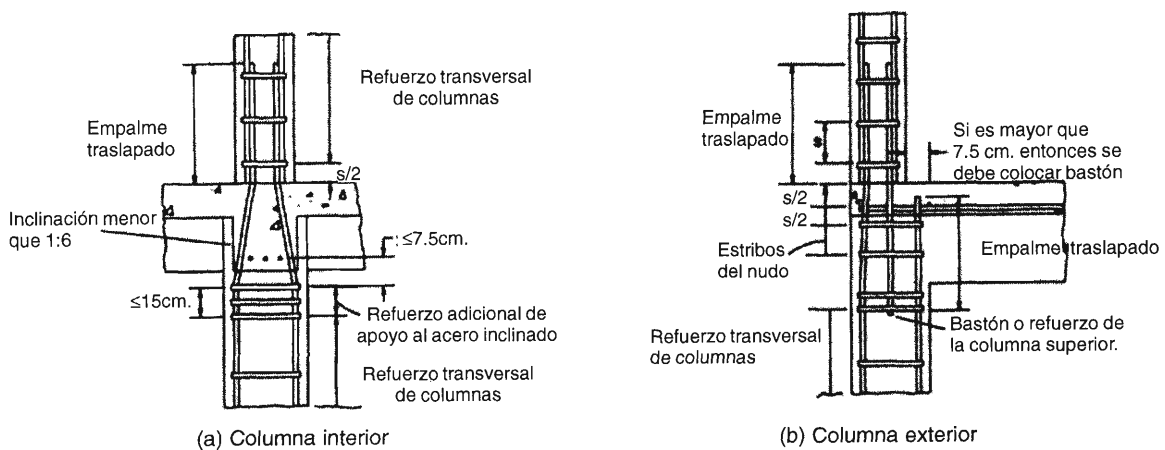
Cambio de sección transversal en columnas de concreto armado
